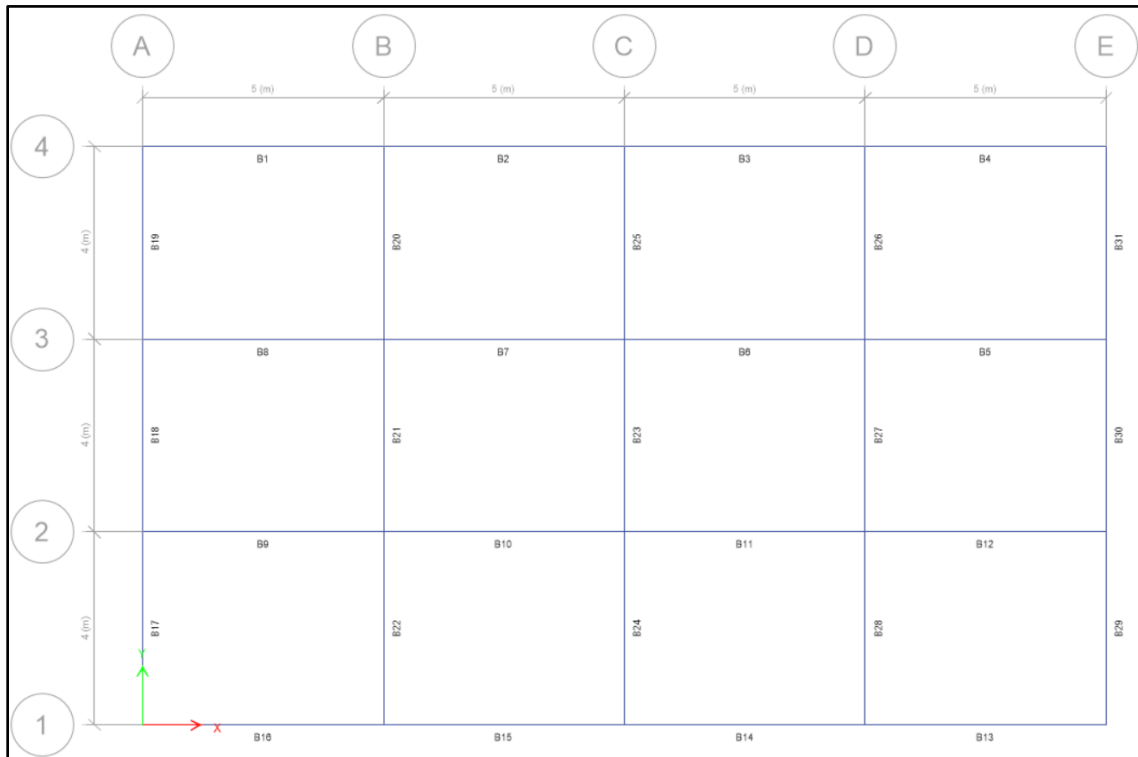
Planta Típica - Visualización de vigas. Fuente: Software Etabs v21
